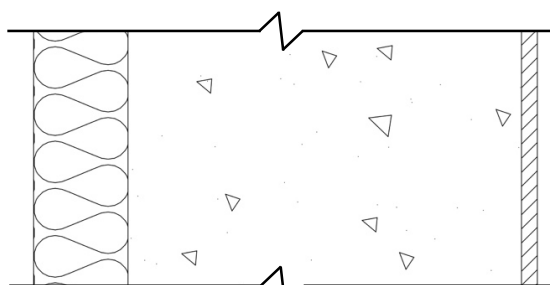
Parede de betão armado constituída por: XPS (ETICS) (6 cm) | Betão armado (25 cm) | Reboco (1 cm).
